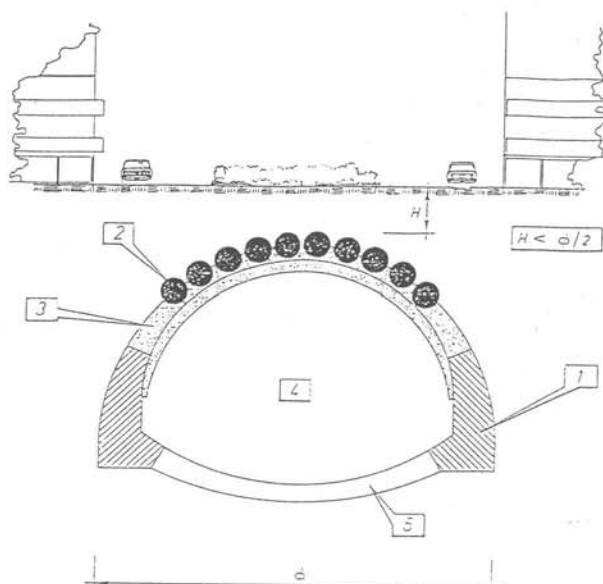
Sintesi delle fasi esecutive dell'«Arco Cellulare»: 1) getto dei piedritti; 2) infissione dei tubi prefabbricati; 3) getto dell'arco di calotta; 4) scavo; 5) getto dell'arco rovescio.
